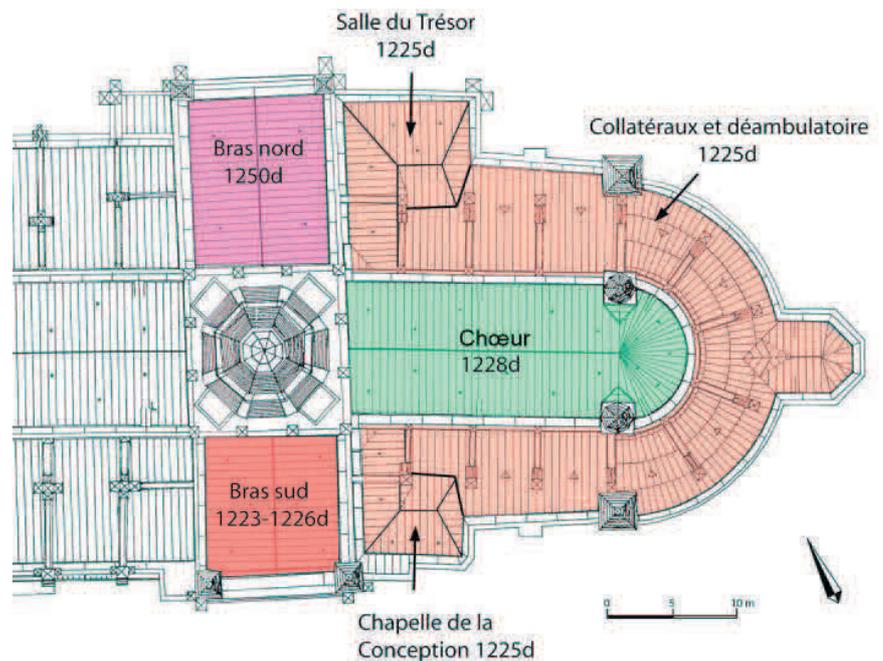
Bayeux, cathédrale, plan des toitures orientales avec datations dendrochronologiques des charpentes (dessin F. Épaud sur fond de plan B. Decaris).
